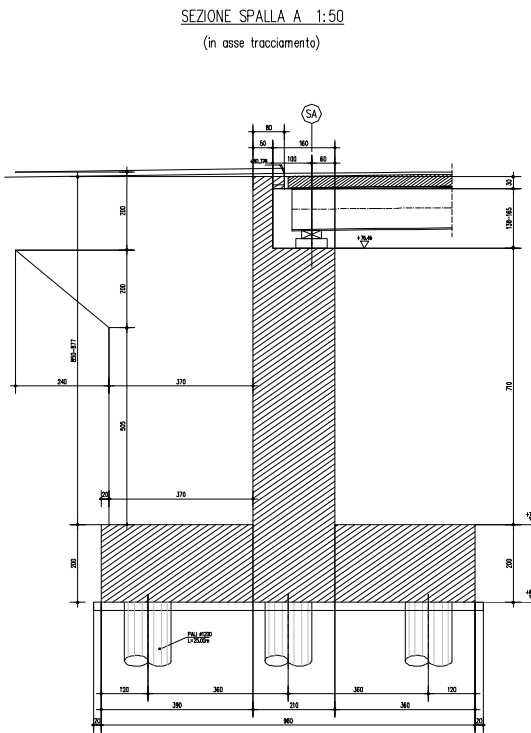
Spalla SA- Sezione trasversale
